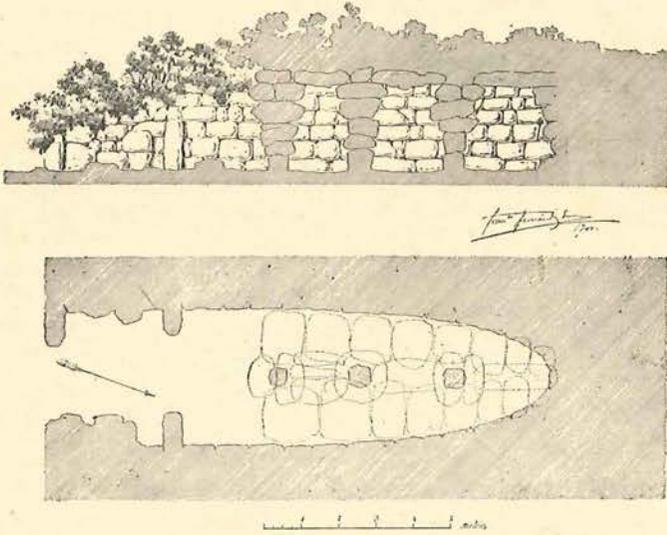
NAUETA DE SON MARGER DE BAIX. — Coupe et plan.
